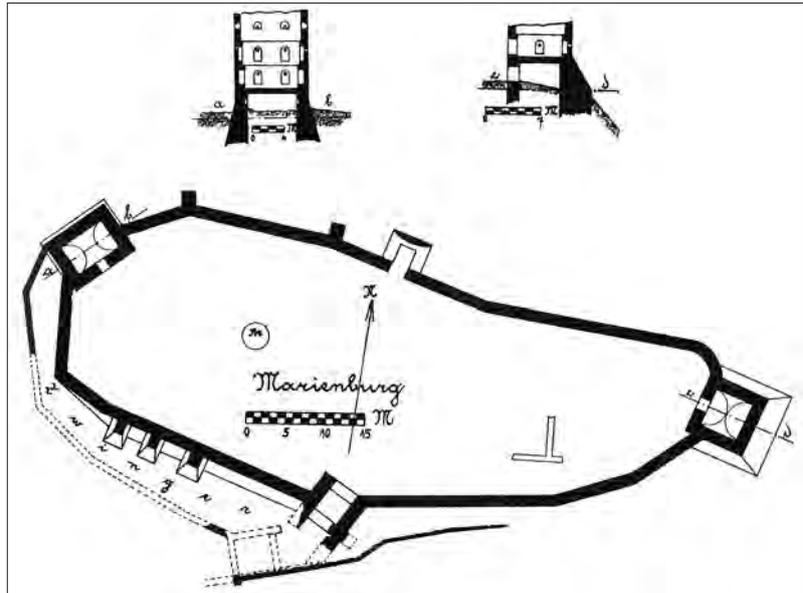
Grundriss der Marienburg, 1929.
